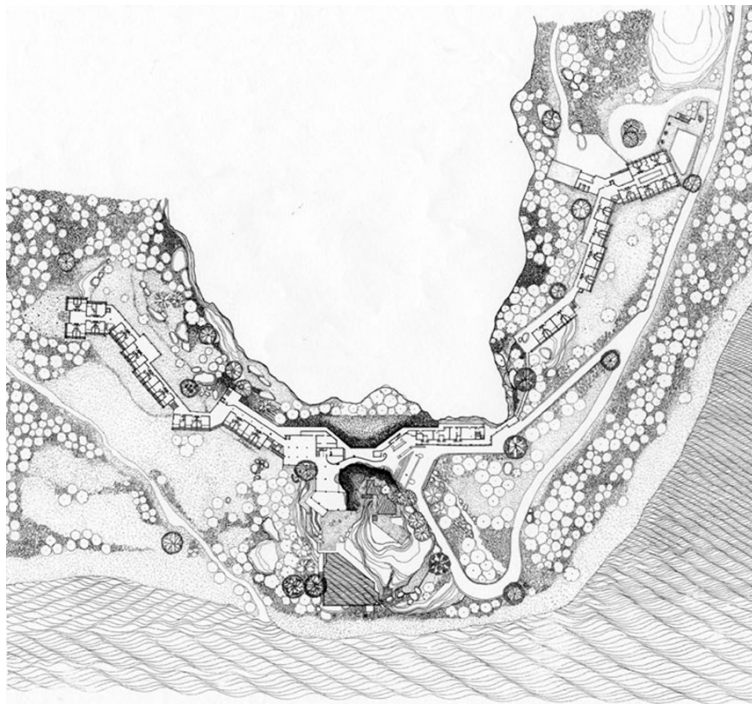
Hotel Kandalama. Sri Lanka. Vista en planta. Arquitecto Geoffrey Bawa.
